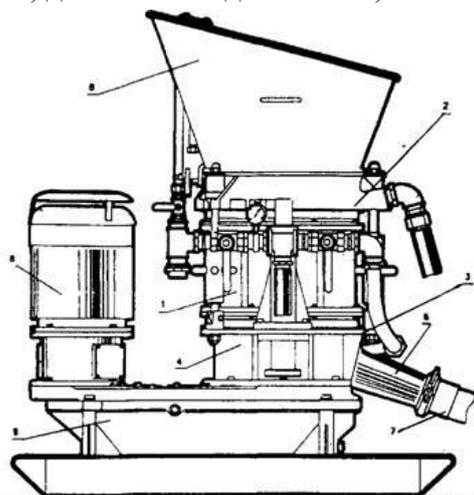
Бетоноукладчик БМ-86: 1-барабан, 2 - неподвижный верхний диск, 3 - неподвижный нижний диск, 4 - основание дозатора, 5 - входной патрубок, 6 - загрузочная воронка, 7 - материальный шланг, 8 - электродвигатель, 8 - редуктор.
